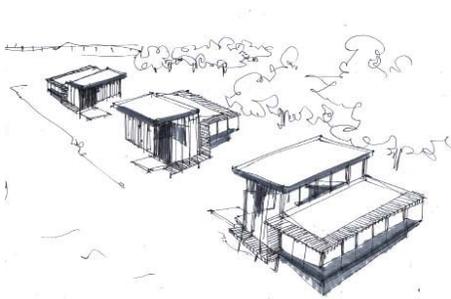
/ PROYECTO CUBICULA DE VIDRIO.
